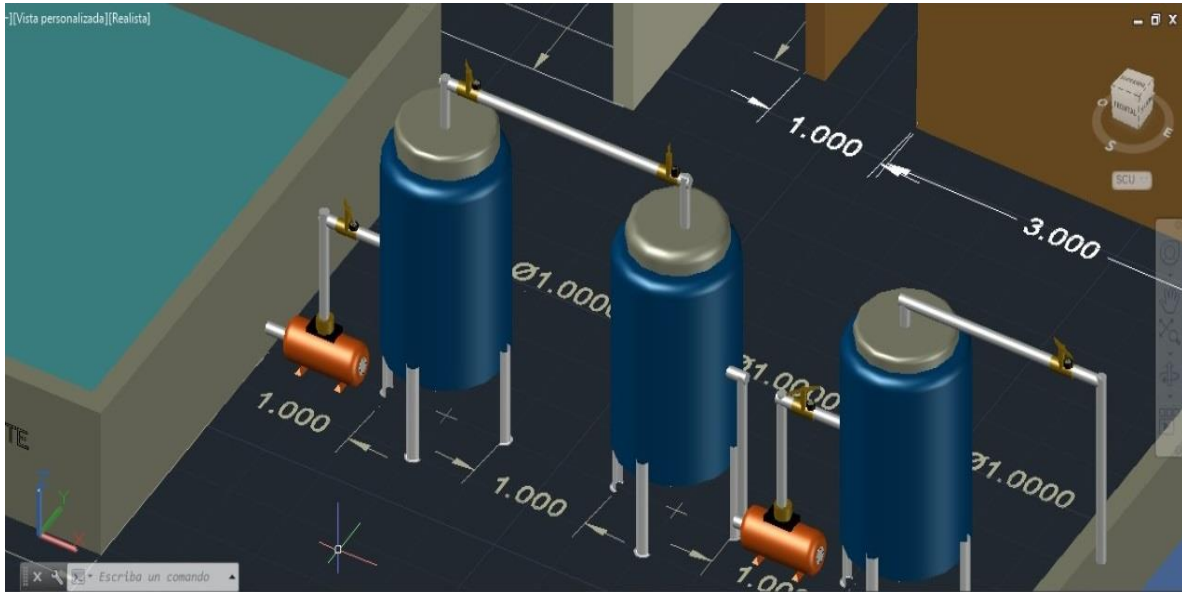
Vista frontal de las columnas de filtración y de resinas de intercambio iónico que conforman la planta propuesta para recuperación de agua mediante la alternativa 1.
